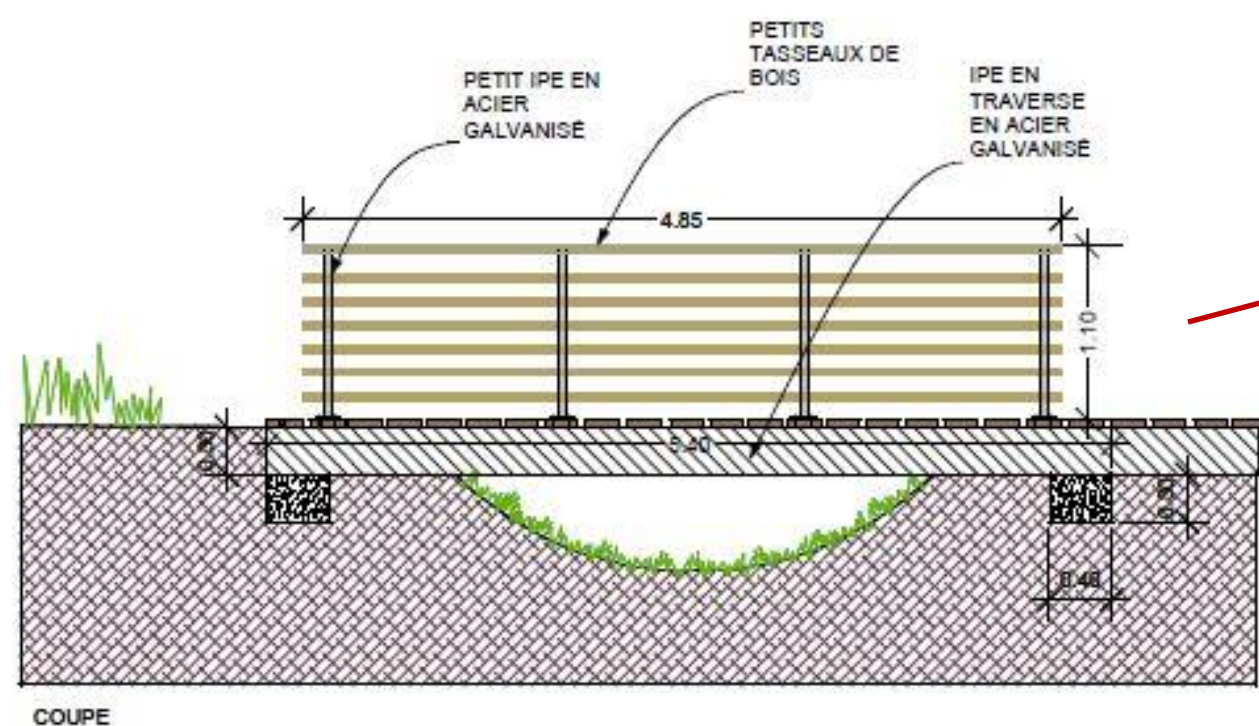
coupe type de la passerelle piétonne (source : APD PL note technique, éTEC, aout 2019)
